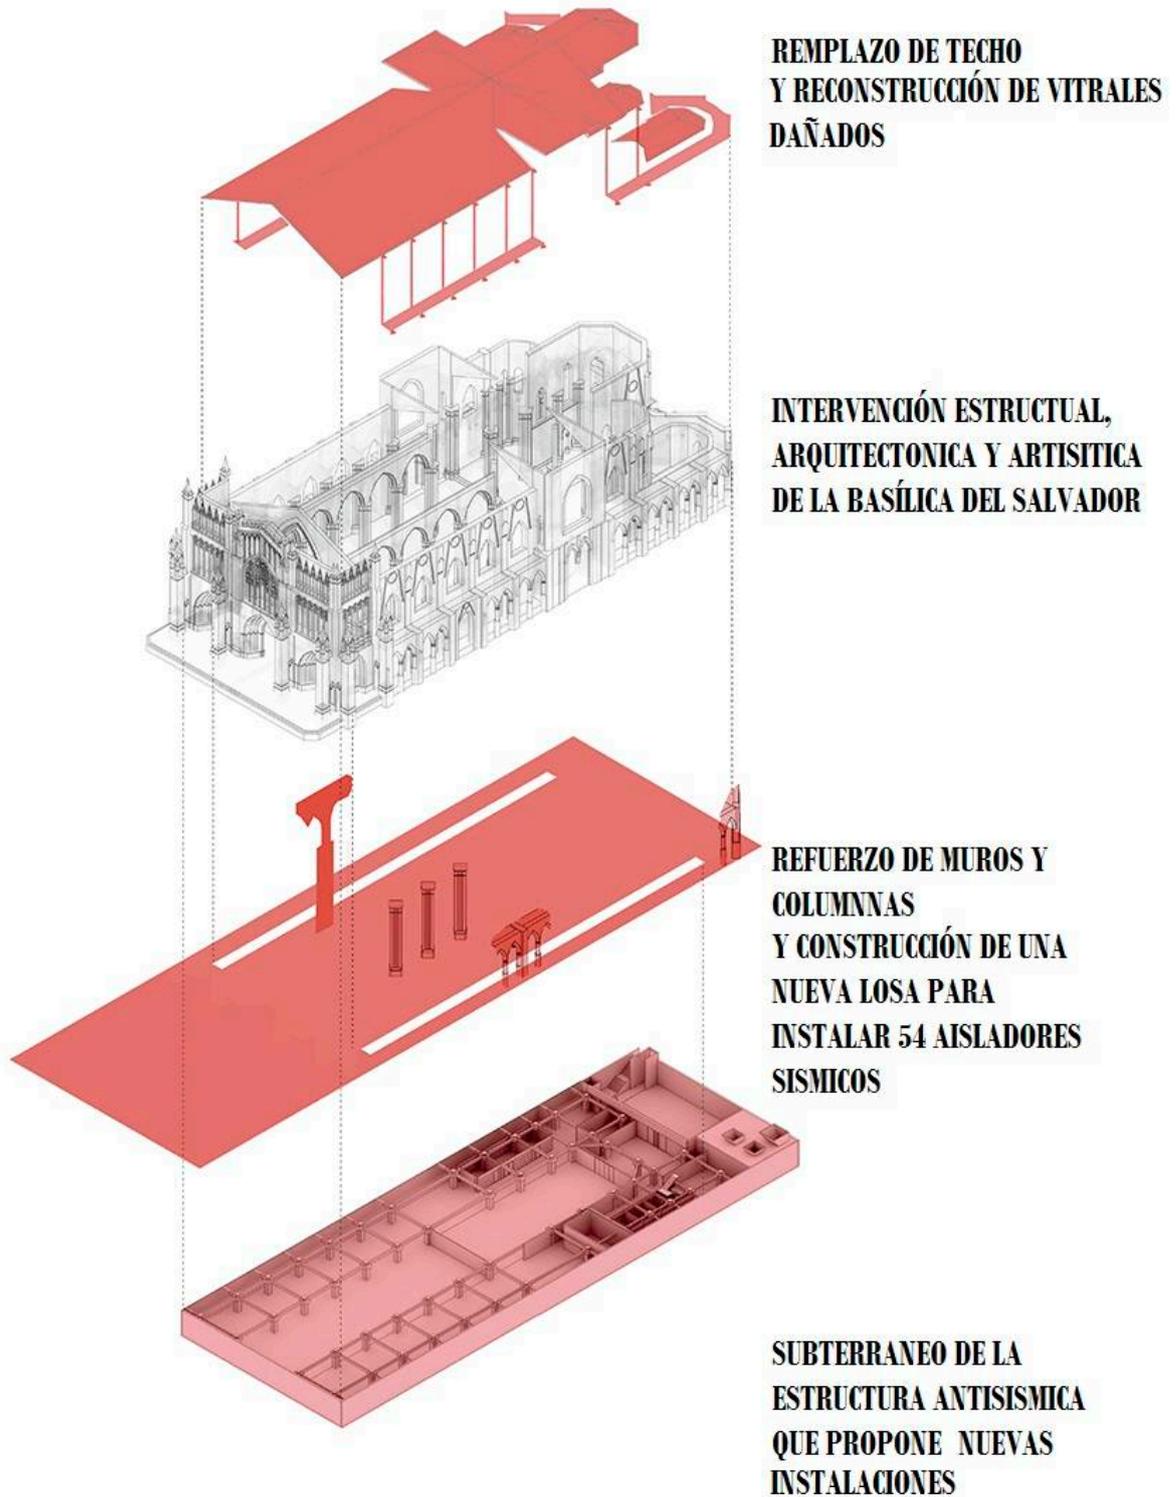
Proyecto subterráneo de la Basílica del Salvador.
